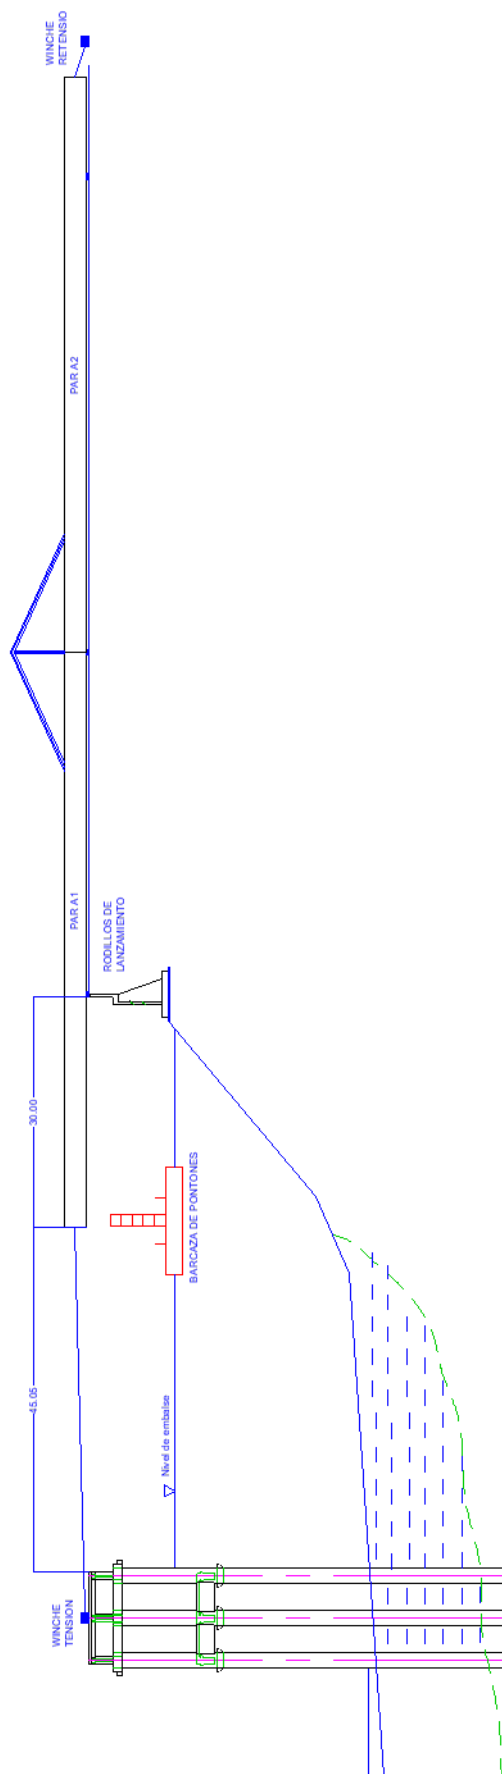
Fase de arrastrar y retener las vigas hasta pasar 18.5 metros la pila auxiliar
